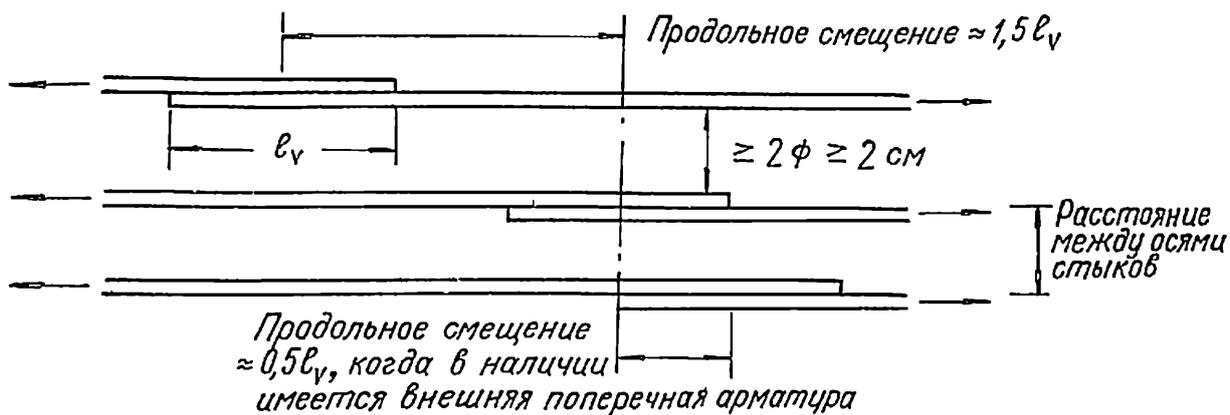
3. Более выгодное продольное смещение стыков внахлестку (при крюках лучше только $l \approx 1,5 l_u$)
